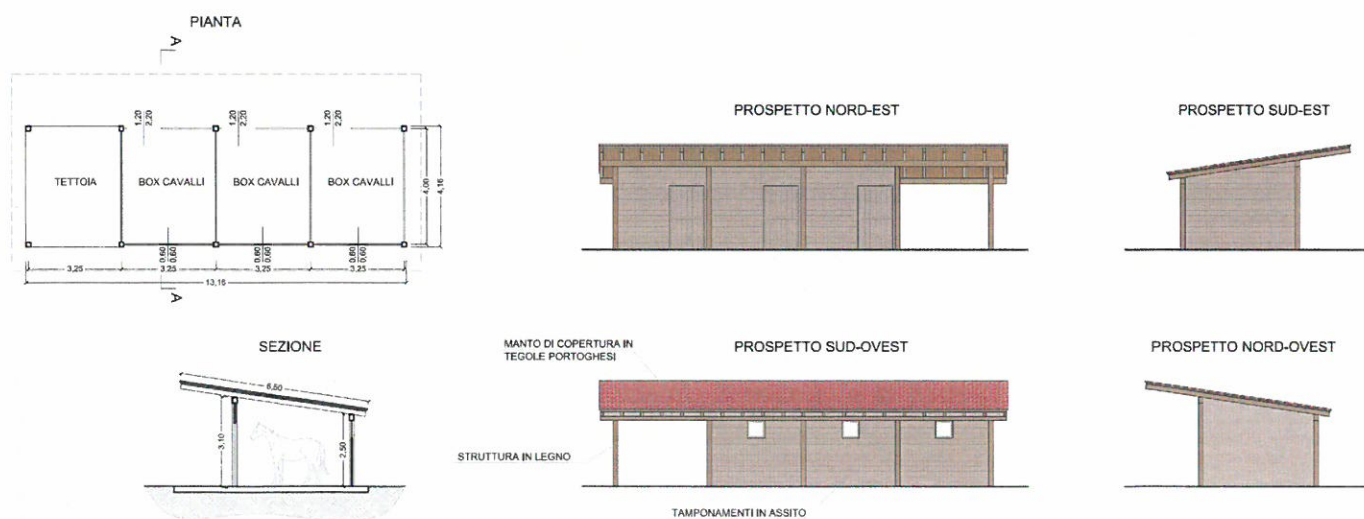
Tettoia e ricovero cavalli in progetto (Fabbr. "D" in planimetria generale)
